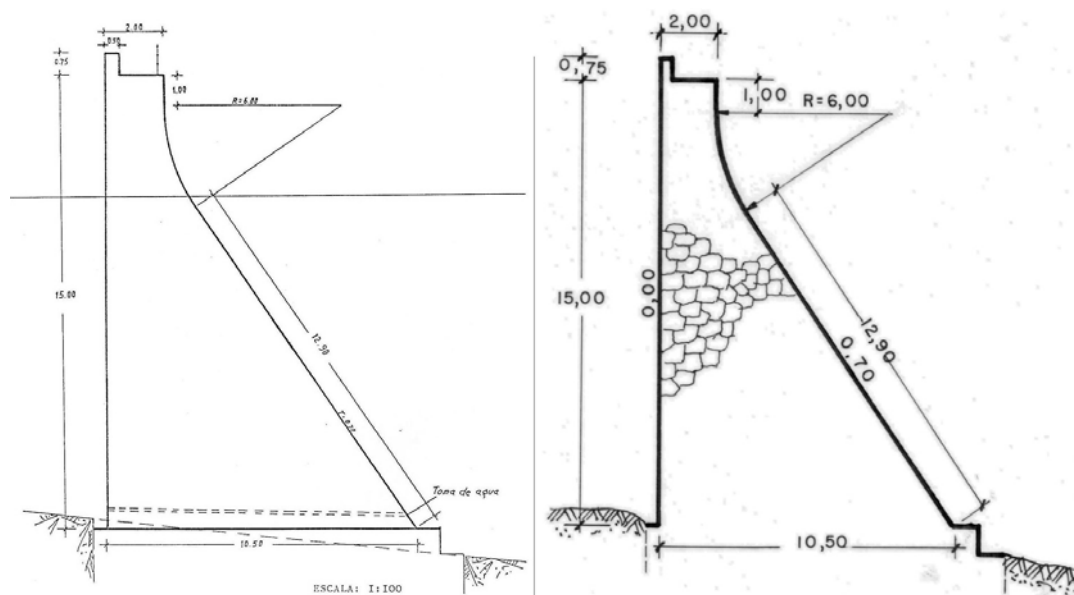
Sección tipo de las 3 presas escalonadas del Proyecto de 1940
